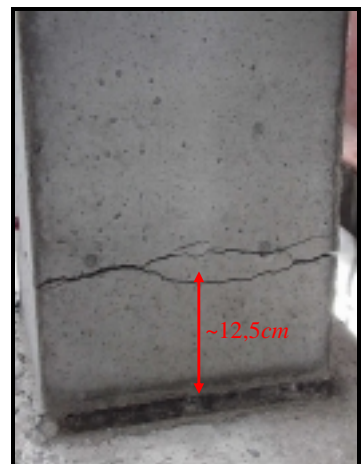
(c) - Fissuração da face traccionada do modelo M3G1.
